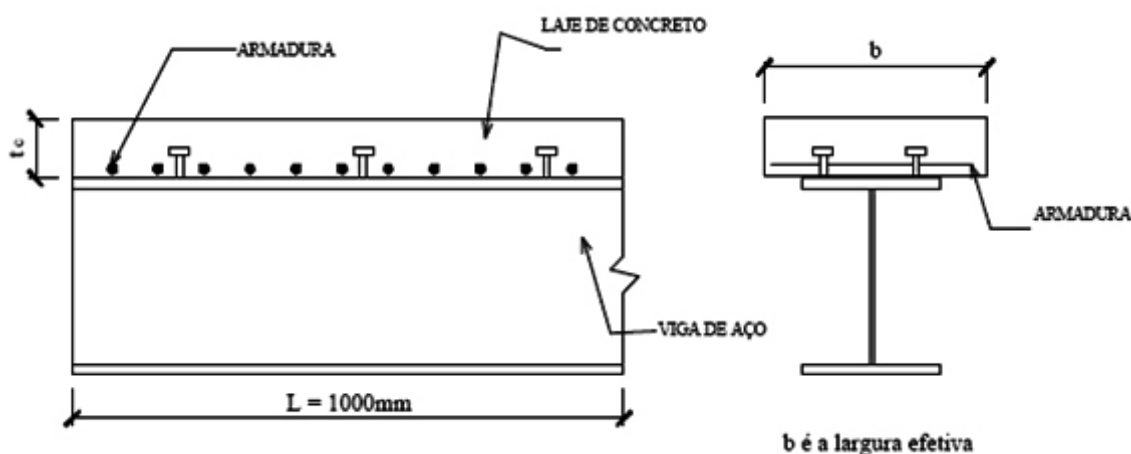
DISPOSIÇÃO DAS ARMADURAS TRANSVERSAIS (ADICIONAIS) NA LAJE DE CONCRETO
